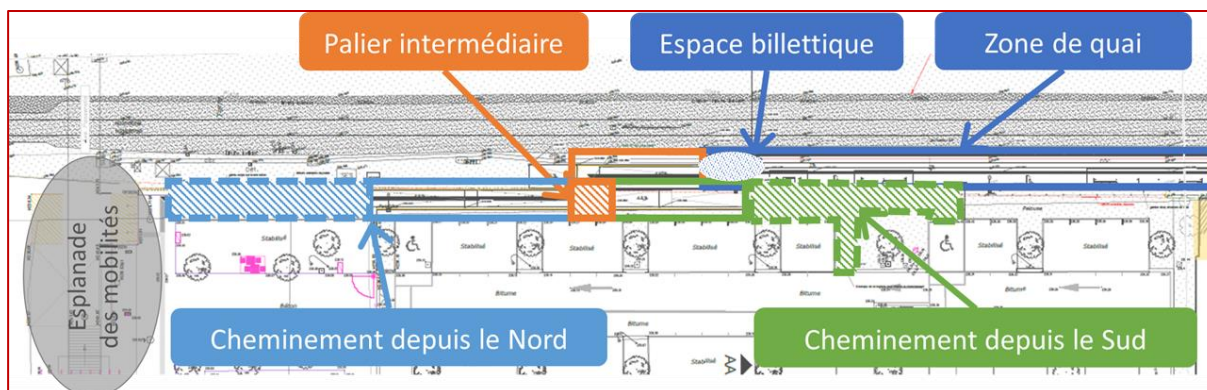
plan de situation de la future halte voyageurs (source : NOTICE Explicative, SNCF 2021)
